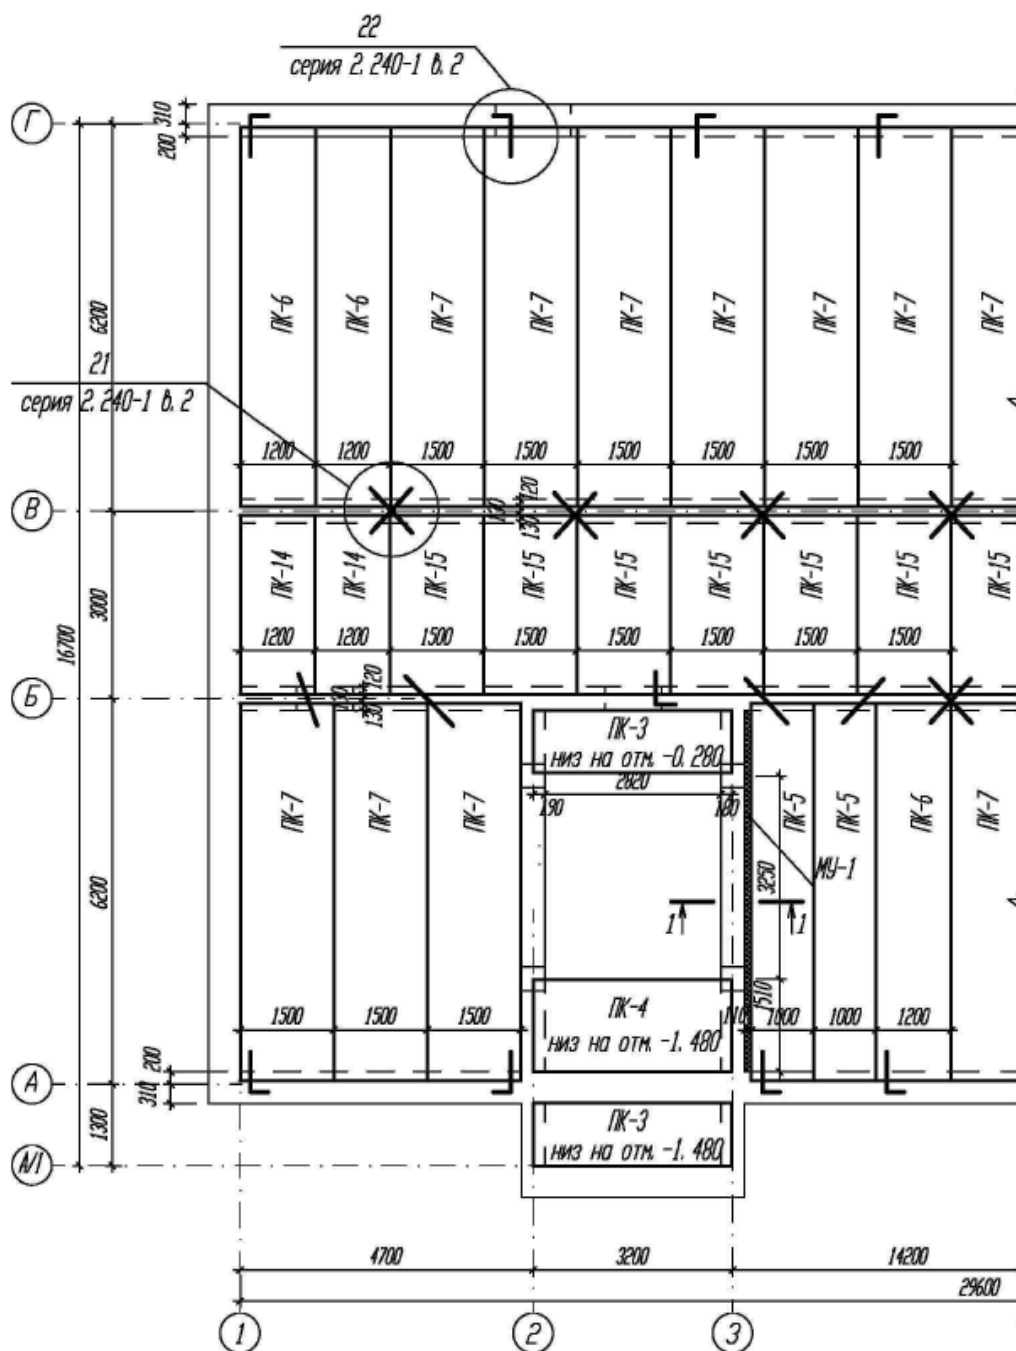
Пример оформления плана раскладки плит перекрытий.
